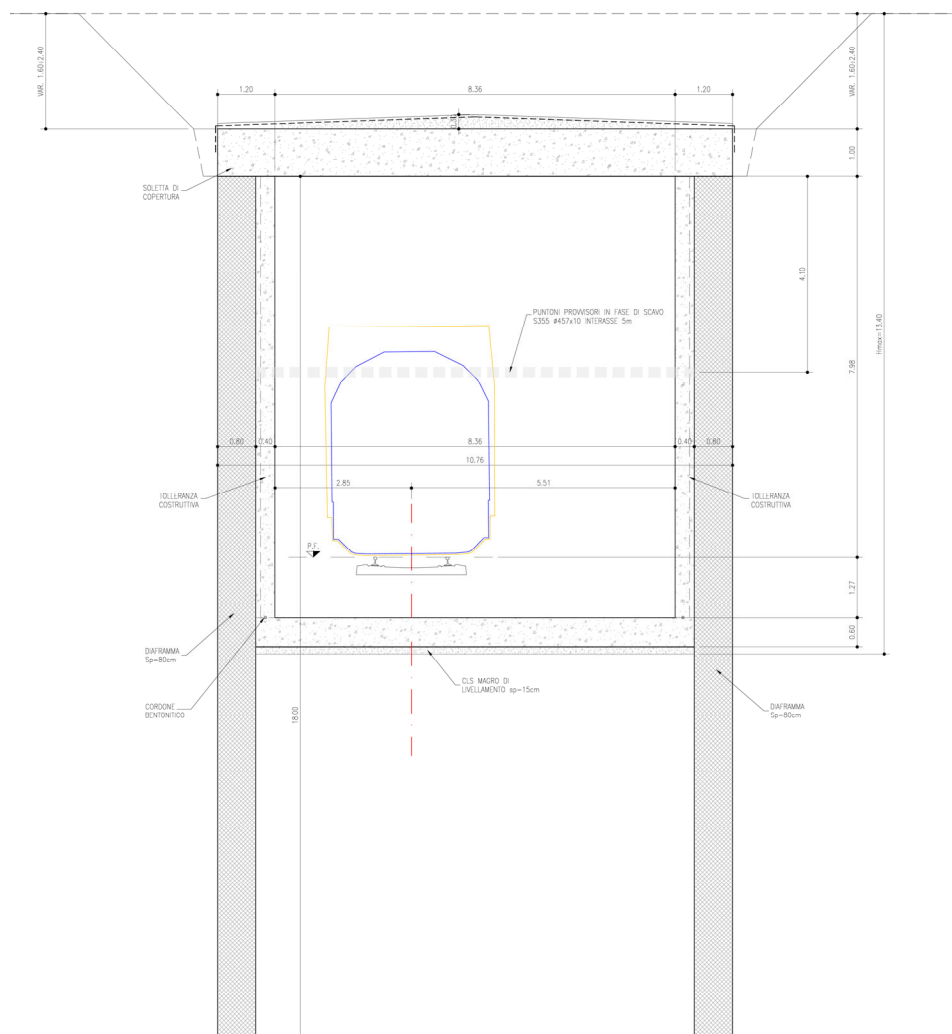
Scavo con diaframmi – sezione TIPO Lb1
